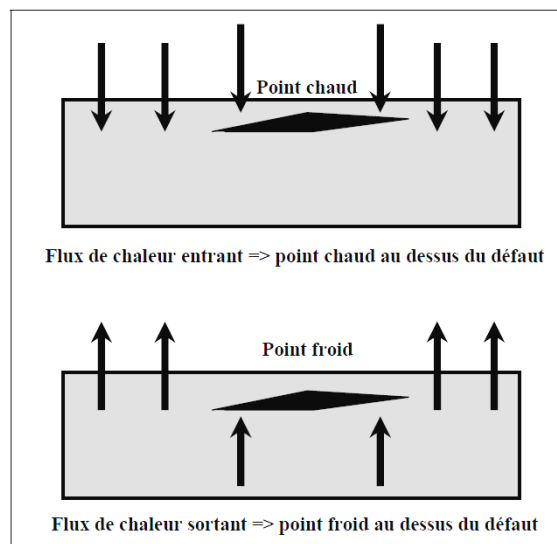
effet d'un vide sur la propagation de la chaleur d'une dalle en béton [Carino 03]
